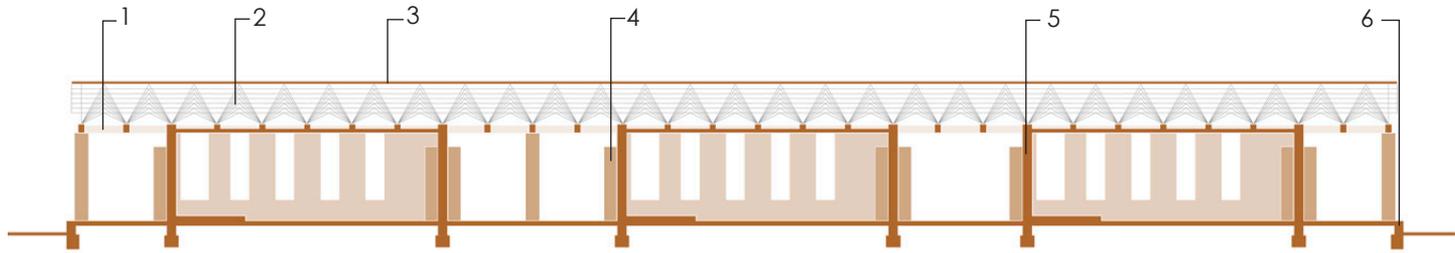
Esquema de sección. 1. Viga de hormigón. 2. Cercha metálica. 3. Cubierta de zinc. 4. Contrafuertes. 5. Muro de carga de ladrillo de adobe. 6. Zócalo de piedra
